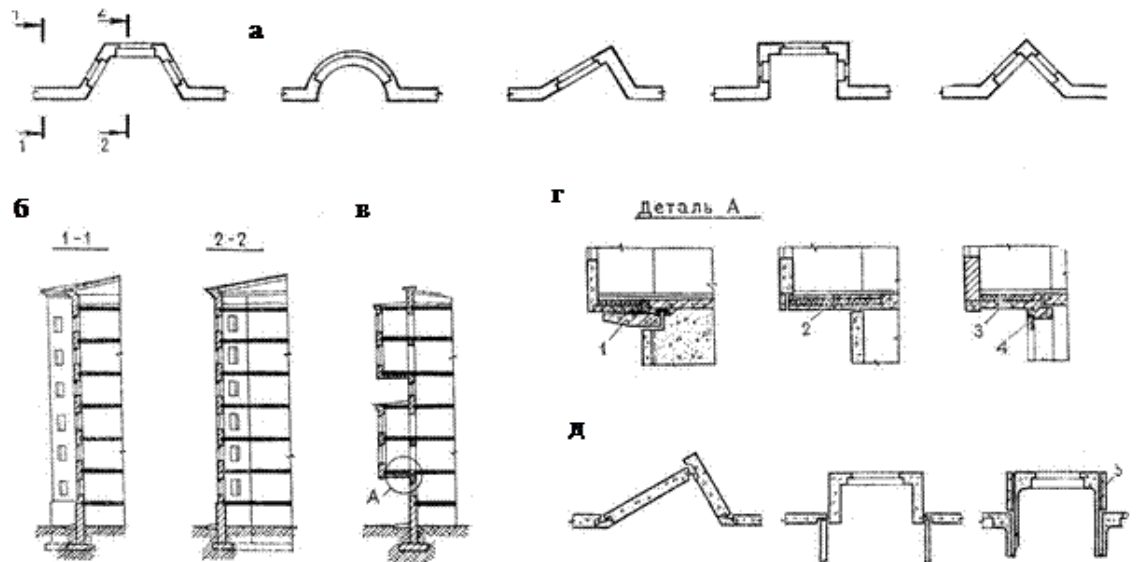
Эркеры а – формы эркеров; б – эркер с несущими стенами; в – навесной эркер; г – конструкции навесных эркеров; д – конструкции эркеров из панелей и объемных блоков; 1 – железобетонная консоль; 2 – консоль перекрытия; 3 – консольная керамзитобетонная плита эркера; 4 – оконная перемычка; 5 – утепляющая панель.
